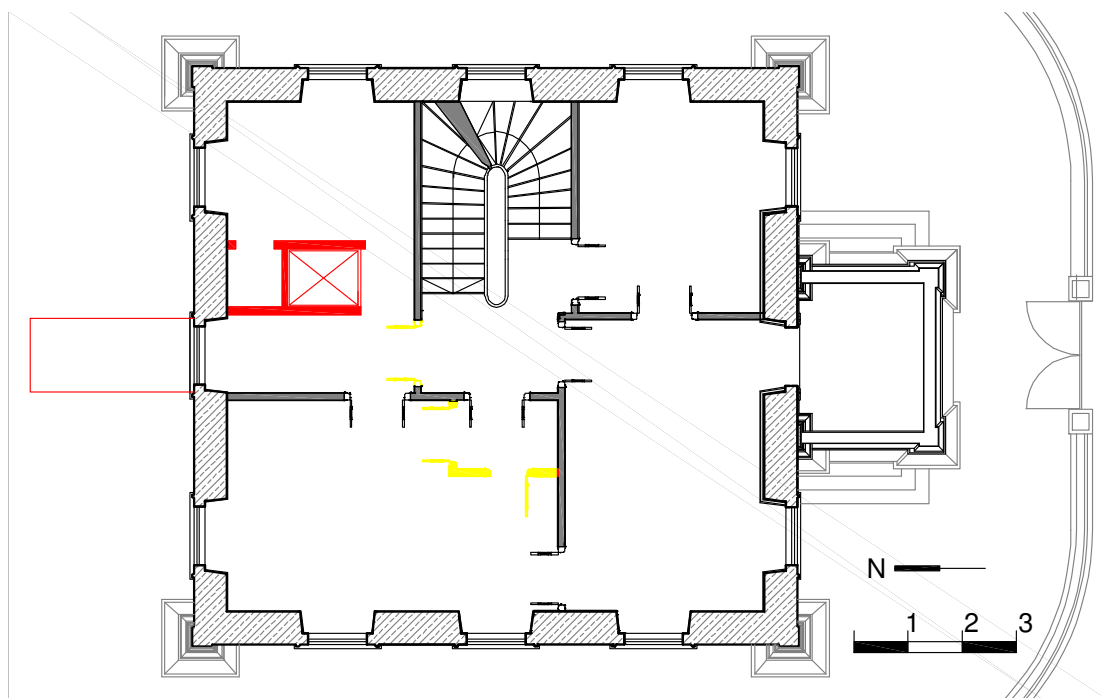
Planta do Piso 2 com as Cores Convencionais
